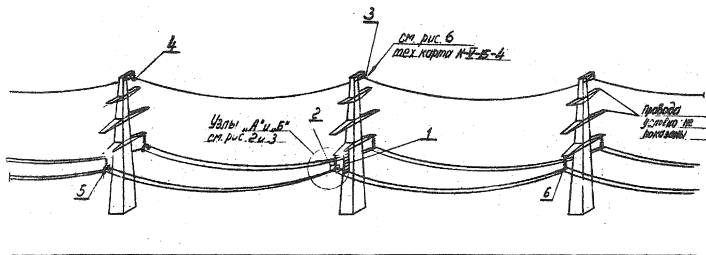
Перекладка проводов и грозозащитного троса без опускания нс землю
